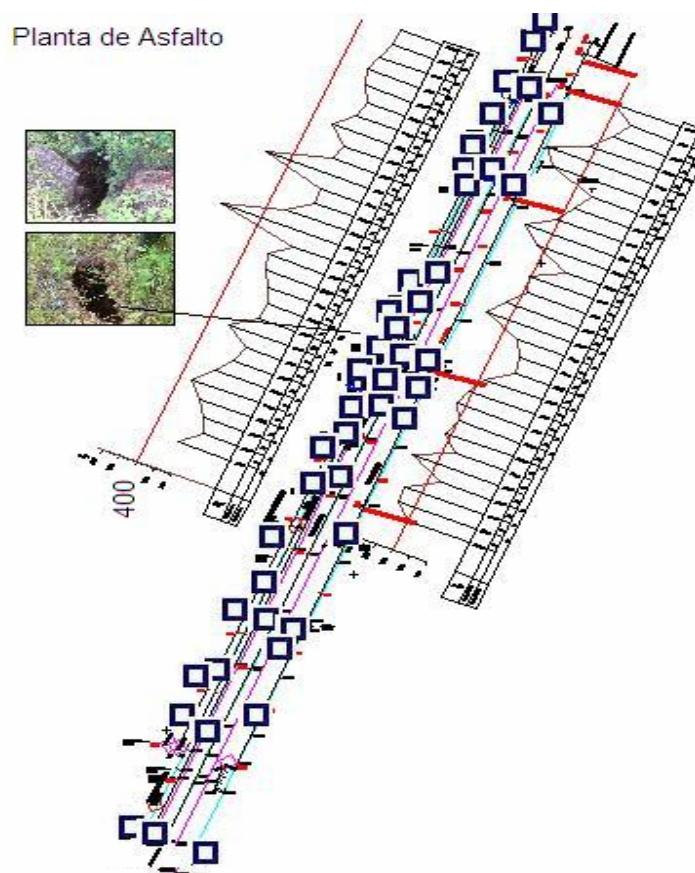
Levantamiento geofísico en Planta de Asfalto.
